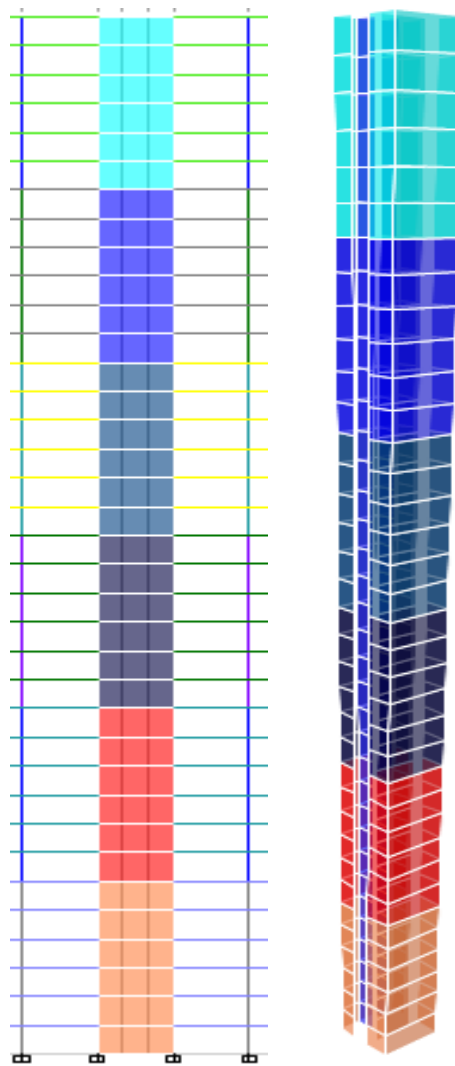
12: Vista en Elevación y 3D de la Caja escalera y ascensor, Edificio tipo C.
